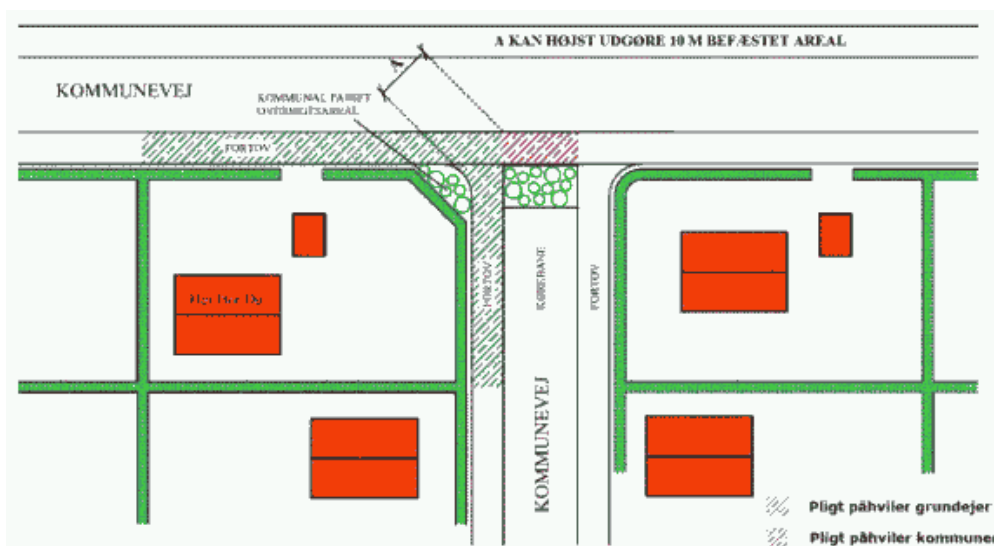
, Hjørnegrund - som figur 1 - hvor pligten kan pålægges grundejeren på alle sider. Her kan grundejeren dog ikke pålægges pligten rundt om oversigtsarealet, da det ikke er nærmest beliggende ejendommen.
